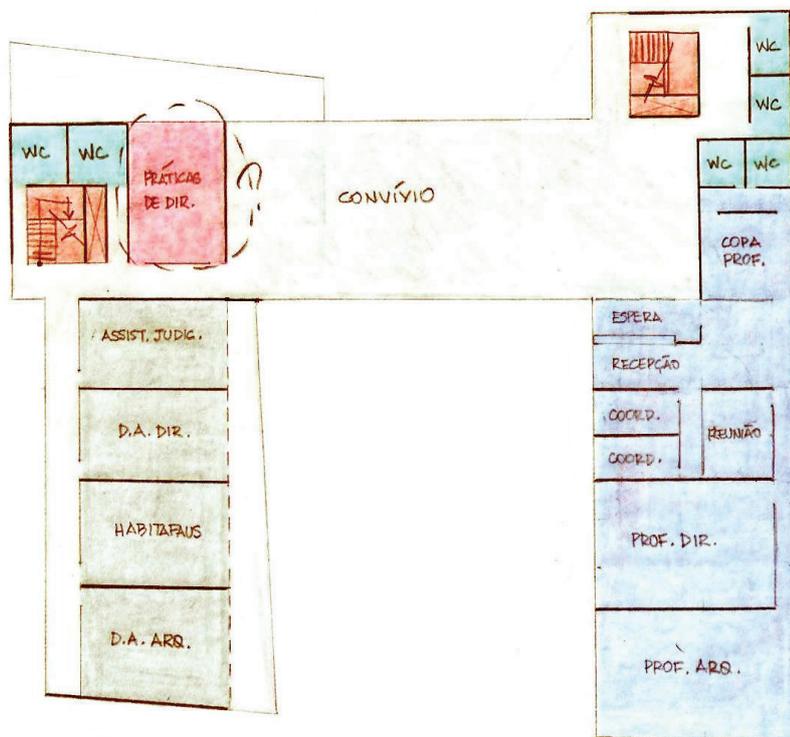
Proposta 4, estudo preliminar, Planta do 1º Pavimento
